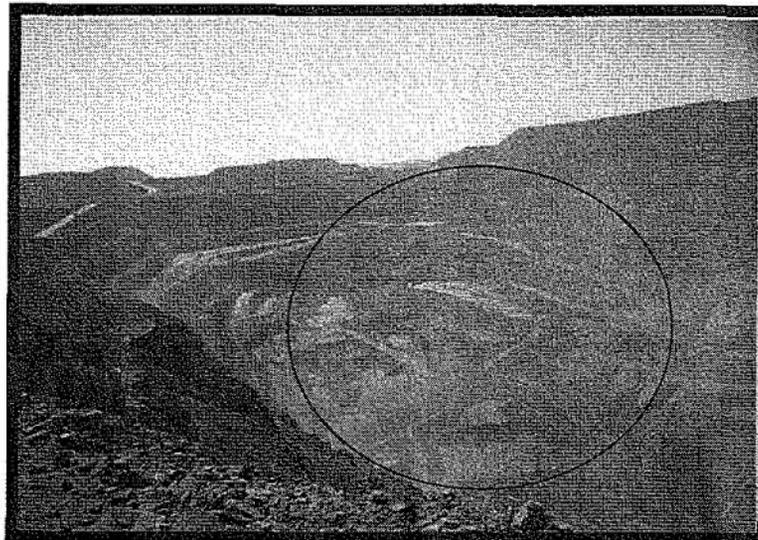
Mina N° 3, en actual operación, donde se observa levantamiento de polvo por las operaciones que se desarrollan en el tajo.
